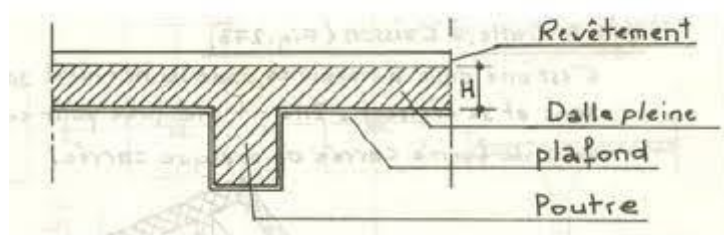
Coupe verticale d'un plancher en dalle pleine
